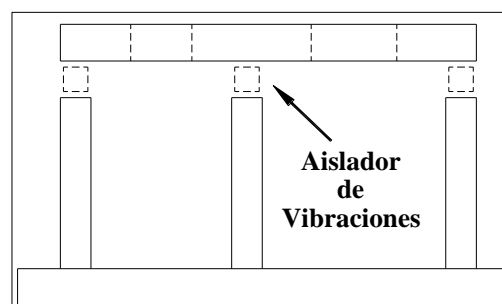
Cimentación Tipo Marco con Aisladores.
